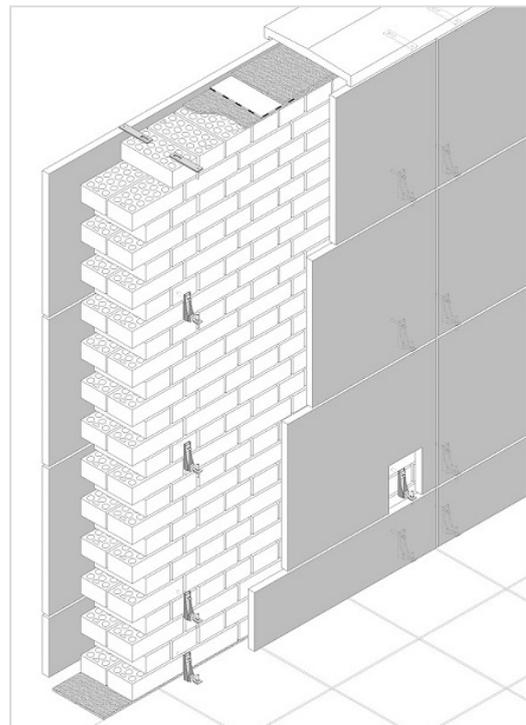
Croquis de detalle constructivo de fachada ventilada de piedra en zona de escalera, situada en la residencia universitaria Galdós.
